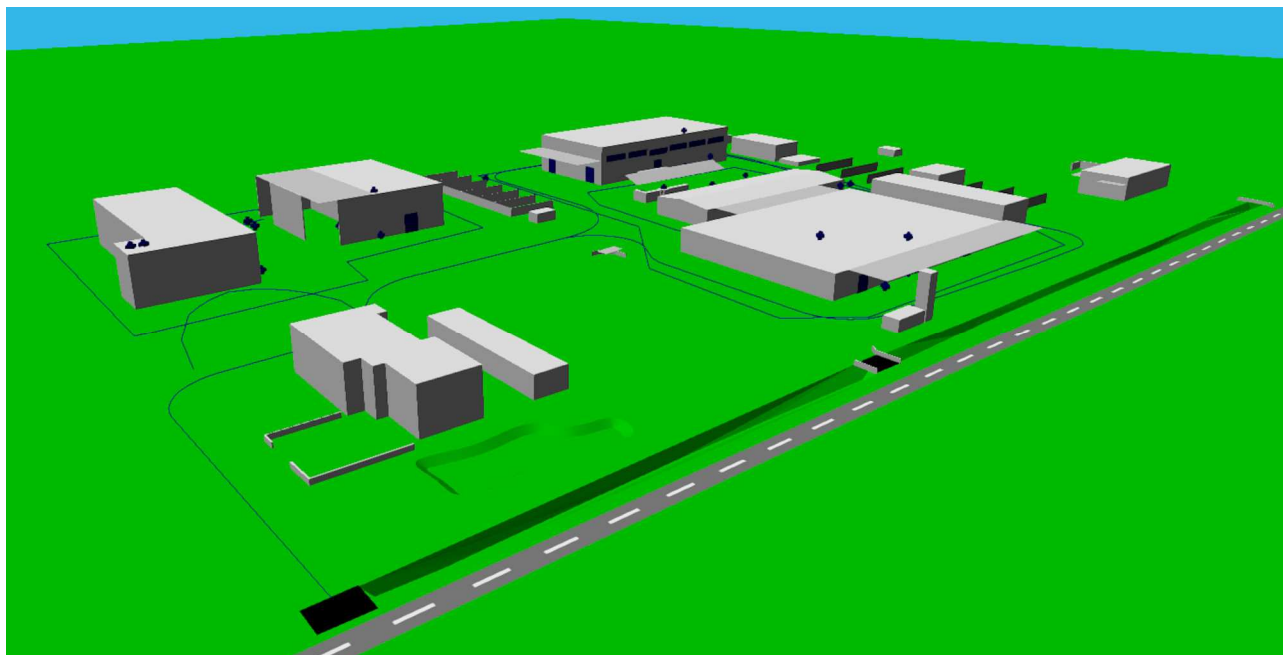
Modello 3D dell'area - stato di progetto - vista Sud Est - dettaglio Tred
